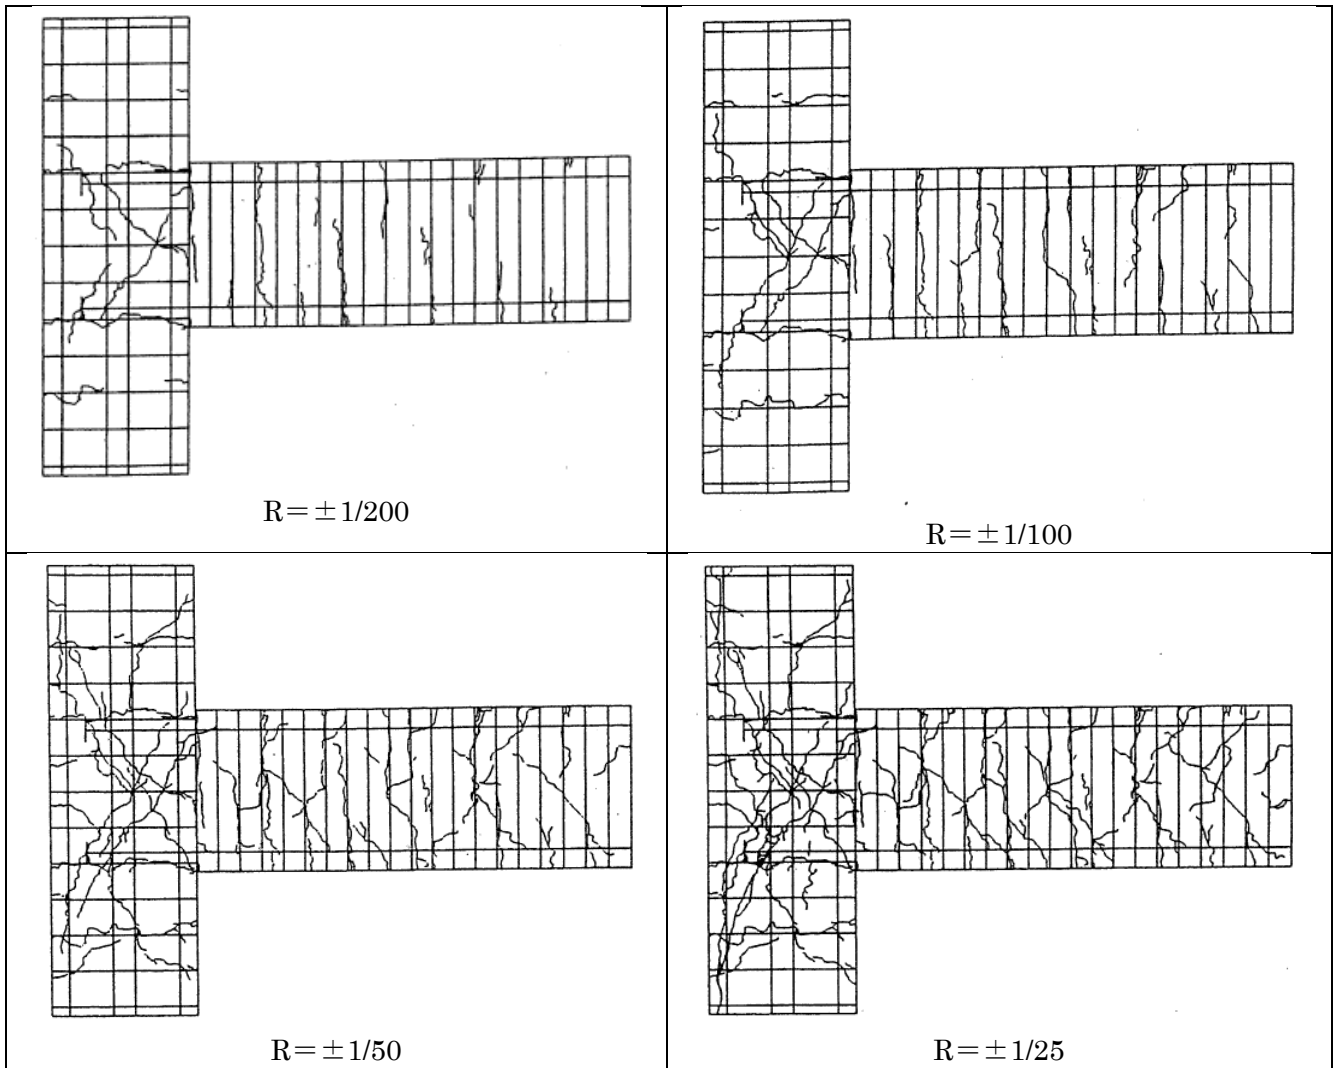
2. 1999No.6 試験体ひび割れ図
